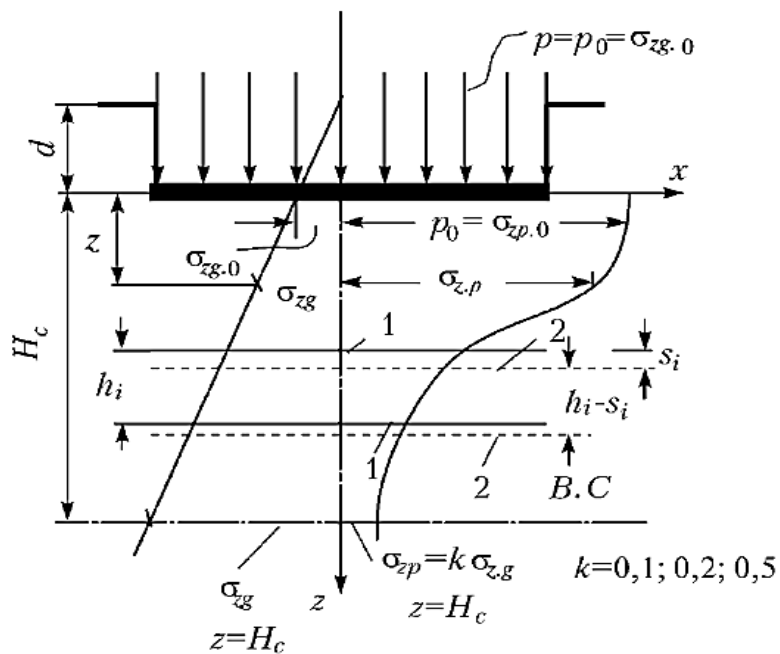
Схема разделения зоны напряжений под фундаментом на элементарные слои
